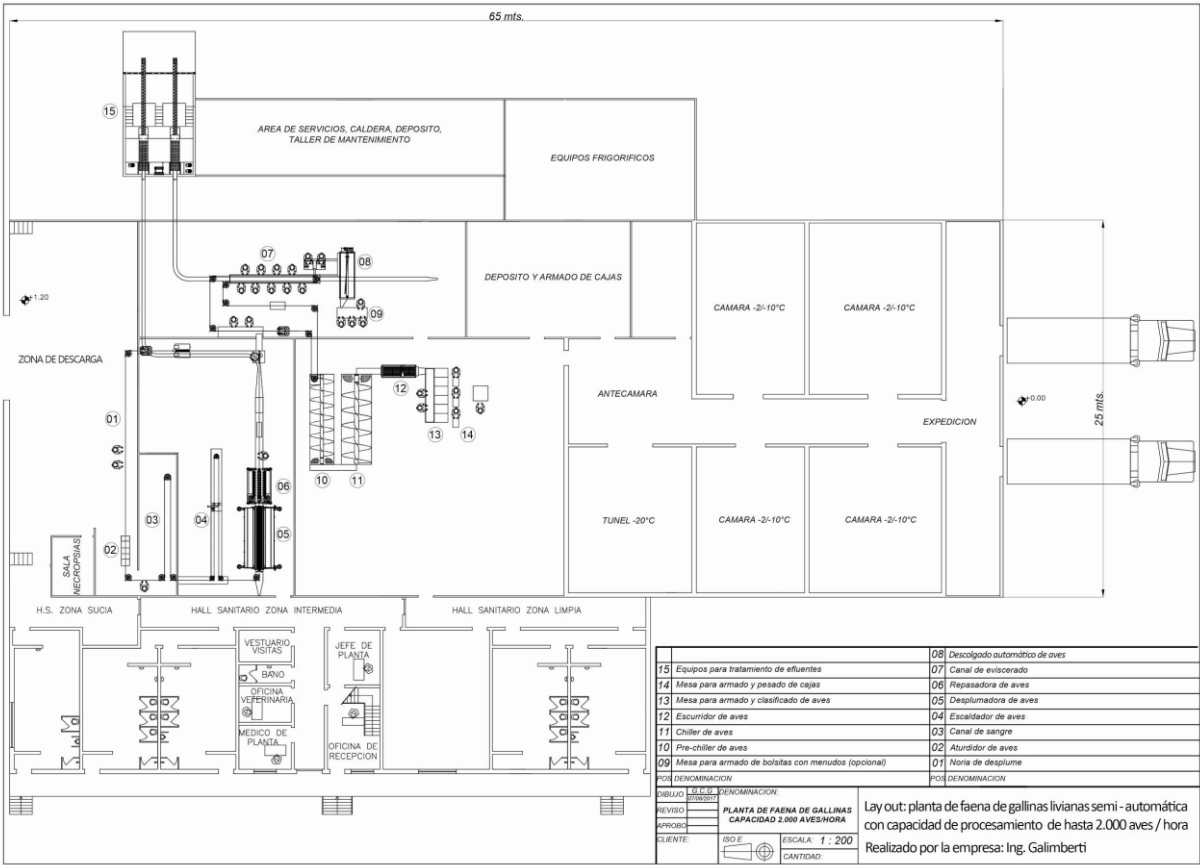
Lay out de la planta, se envía además un archivo con mejor definición.
